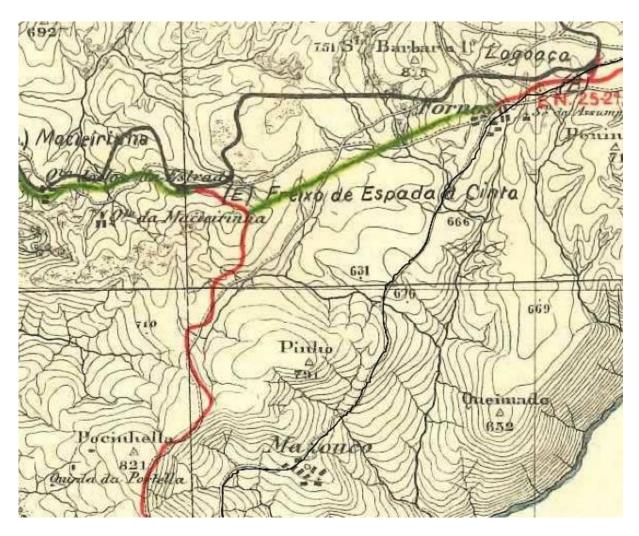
J.A.E., Planta do projeto da E.N. nº 25-2º (a vermelho as estradas existentes, a verde o projeto da estrada e a preto a Linha do Sabor), 1939.
